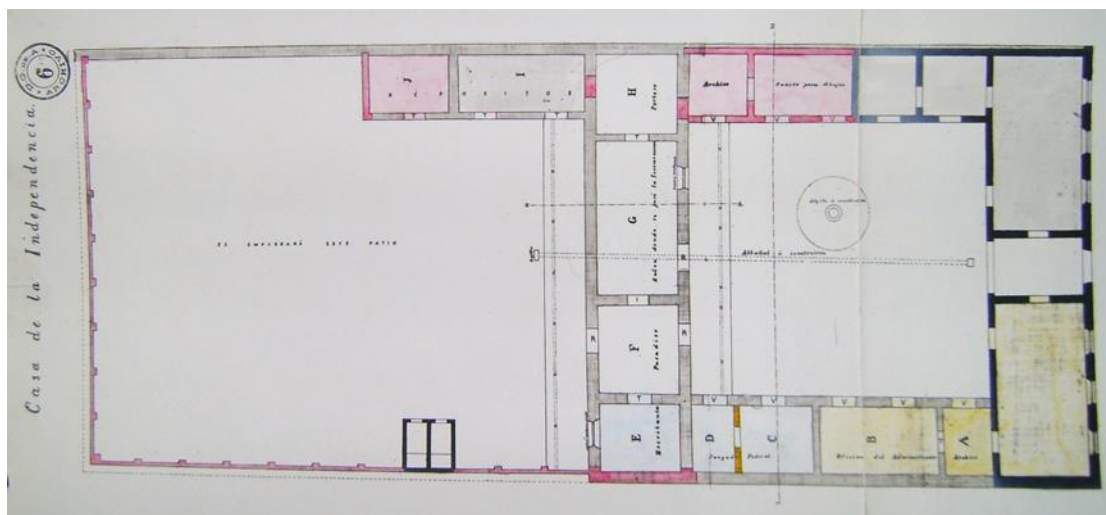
Plano de intervención. Stavelius 1879 Plano N° 5 Detalle. Copia coloreada BMOP
